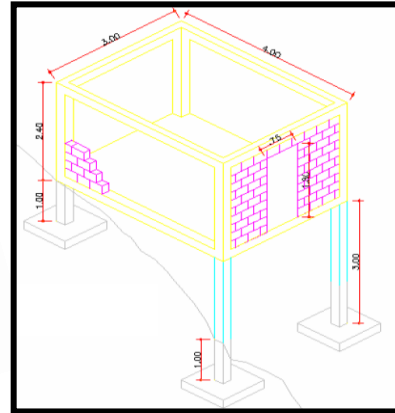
Estructura Aporticada con paredes de relleno.
